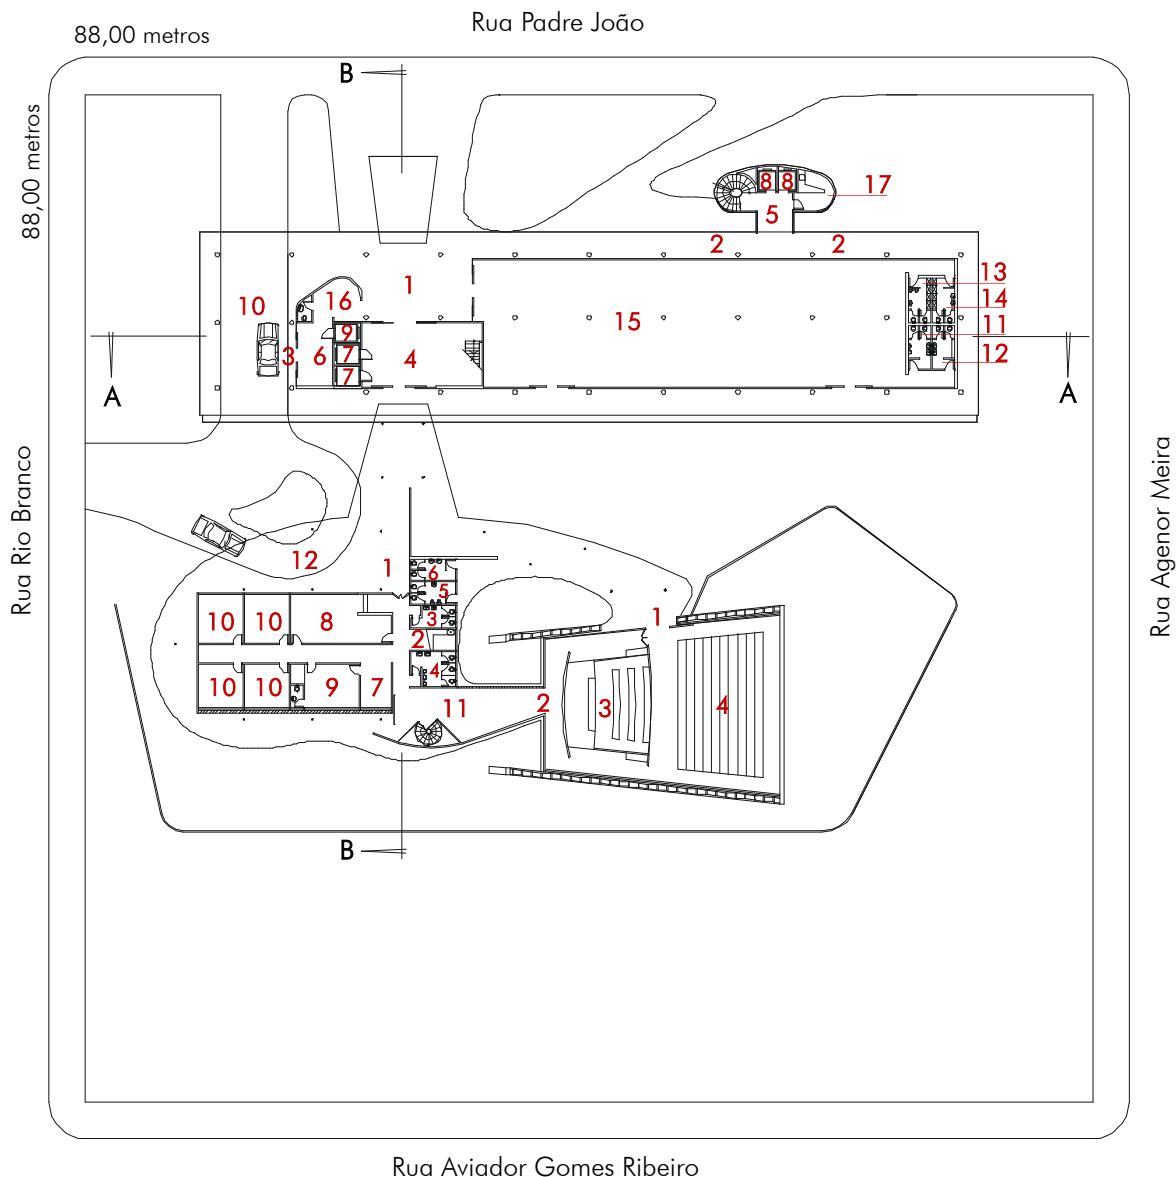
Planta do pavimento térreo: Paço e Câmara Municipal de Bauri.
